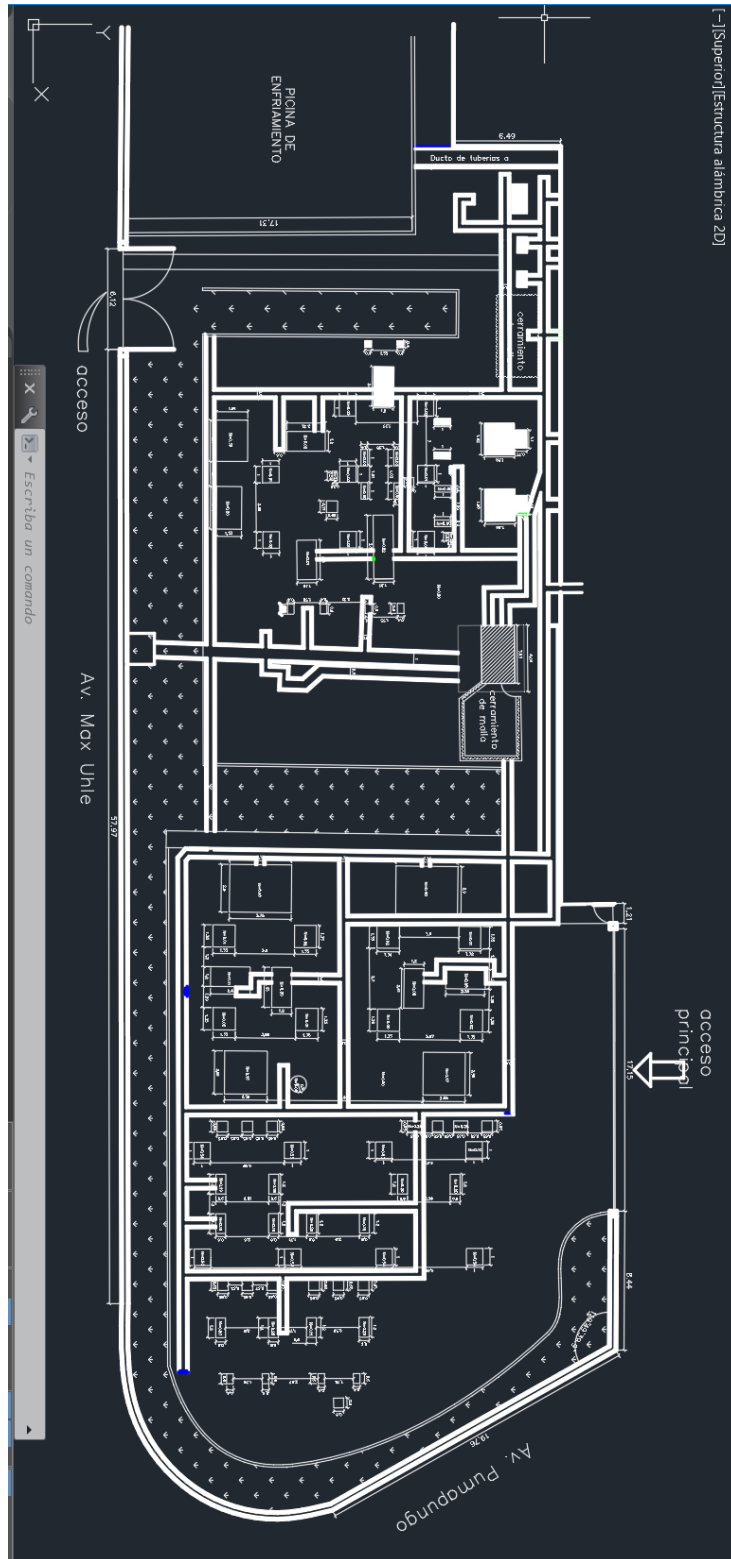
8. Levantamiento Planimétrico S/E 03. Fuente Centro Sur.
